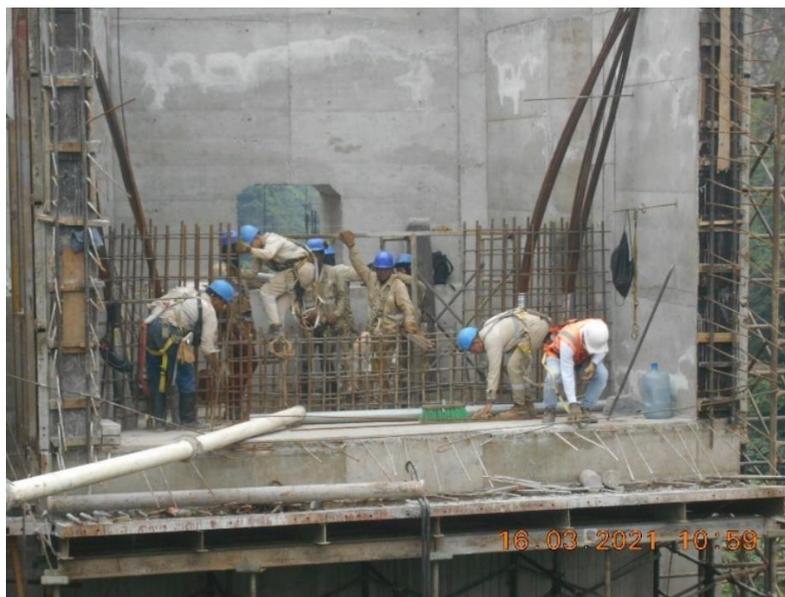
Puente 5: Eje #5; Funden la primer y segunda sección de los muros de la dovela # 0 y 1
